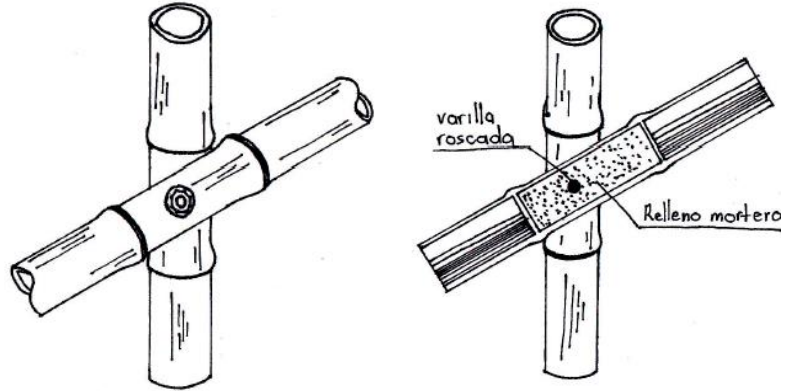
Detalle propuesto para la protección del elemento. Fuente: Elaboración propia.
